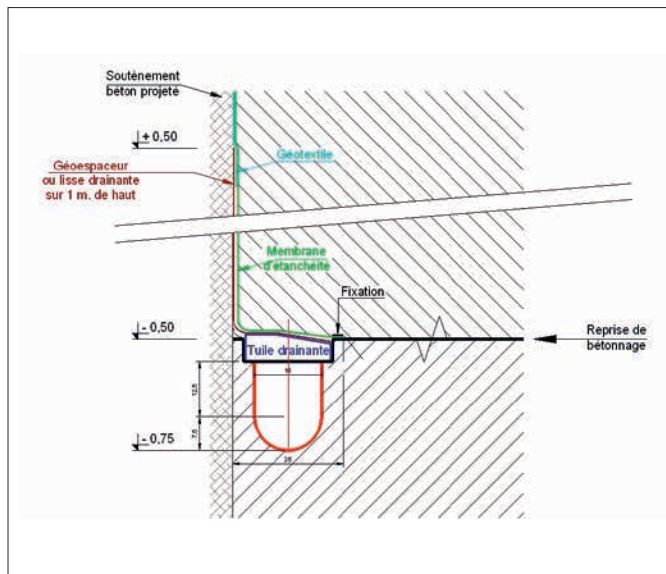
coupe d'un caniveau drainant en base de feuille d'étanchéité
